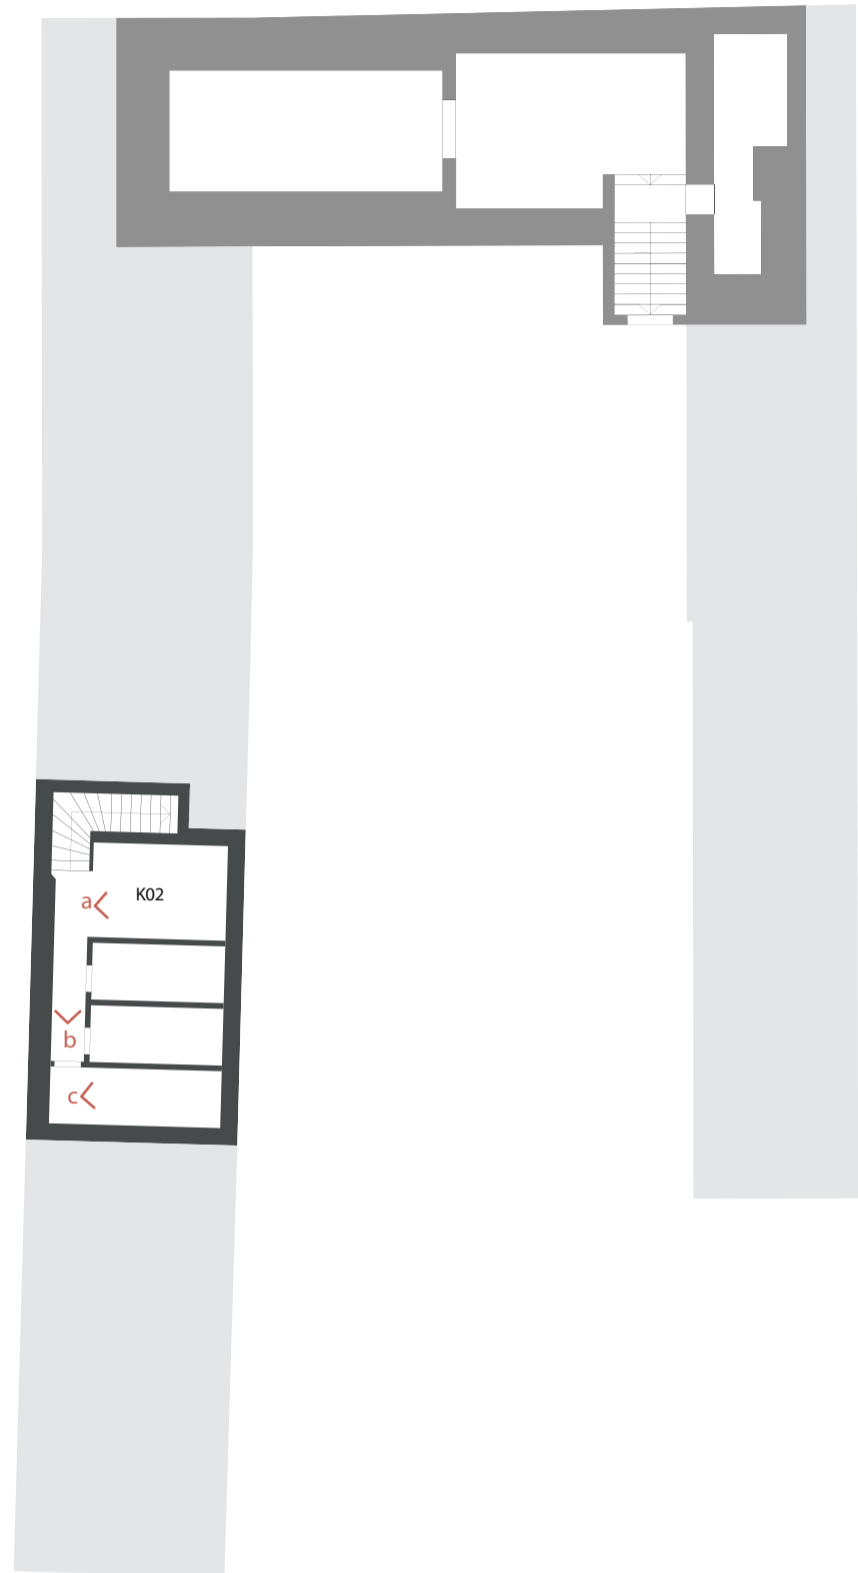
Grundriss Untergeschoß | M 1:200 | Keller 02
